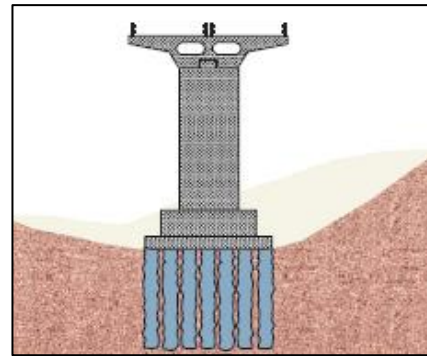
Jet-grouting* aplicado no reforço de fundações
